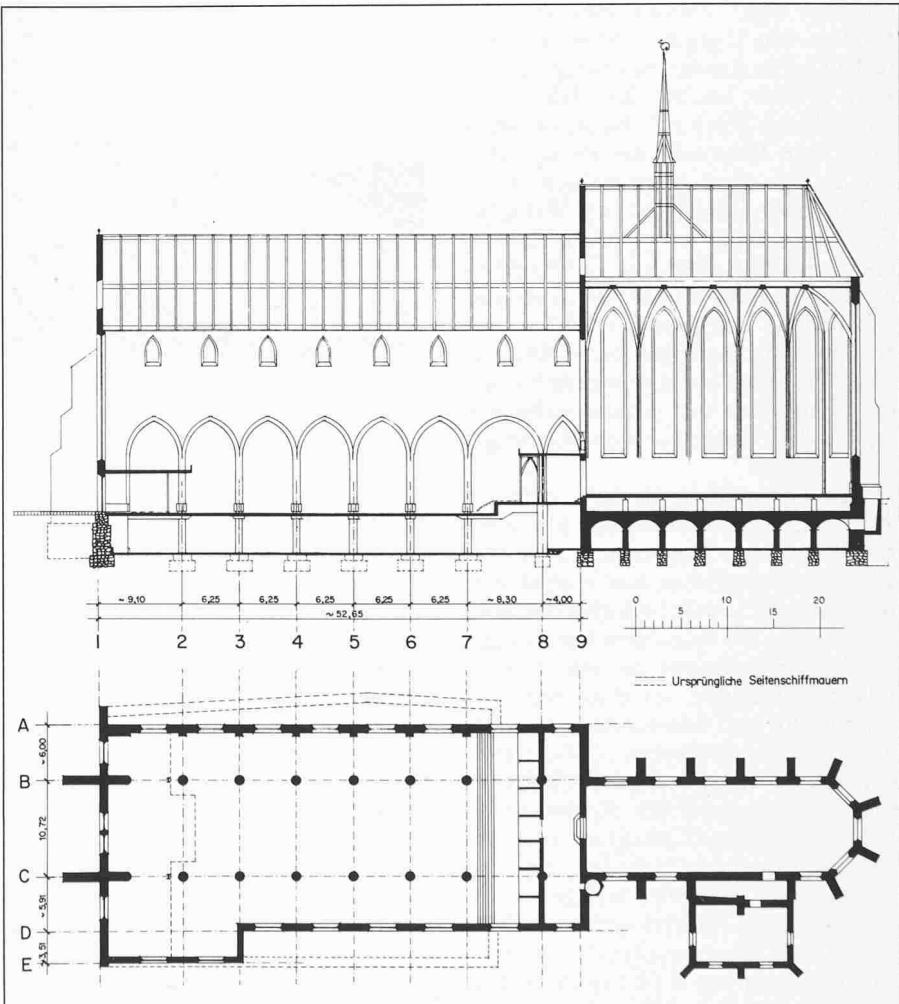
Längsschnitt und Grundriss des Erdgeschosses nach der Renovation. Die beschädigten Pfeiler sind durch genaue Kopien ersetzt worden. Material und Bauweise entsprechen der ursprünglichen Konstruktion. Vor dem Chor steht wieder eine rekonstruierte Lettner. Die verbreiterte Westfassade hat ihre ursprüngliche Gestalt zurück erhalten. Die stilfremden Emporen sind – bis auf eine Galerie zwischen den Achsen 1 und 2 – verschwunden. Das Untergeschoss unter dem Langhaus ist primär eine Sanierungsmassnahme (Beseitigung der Salzrückstände) und subsidiär ein Platzgewinn für das Museum. Der gewölbte Keller unter dem Chor stammt aus dem Jahre 1843.
